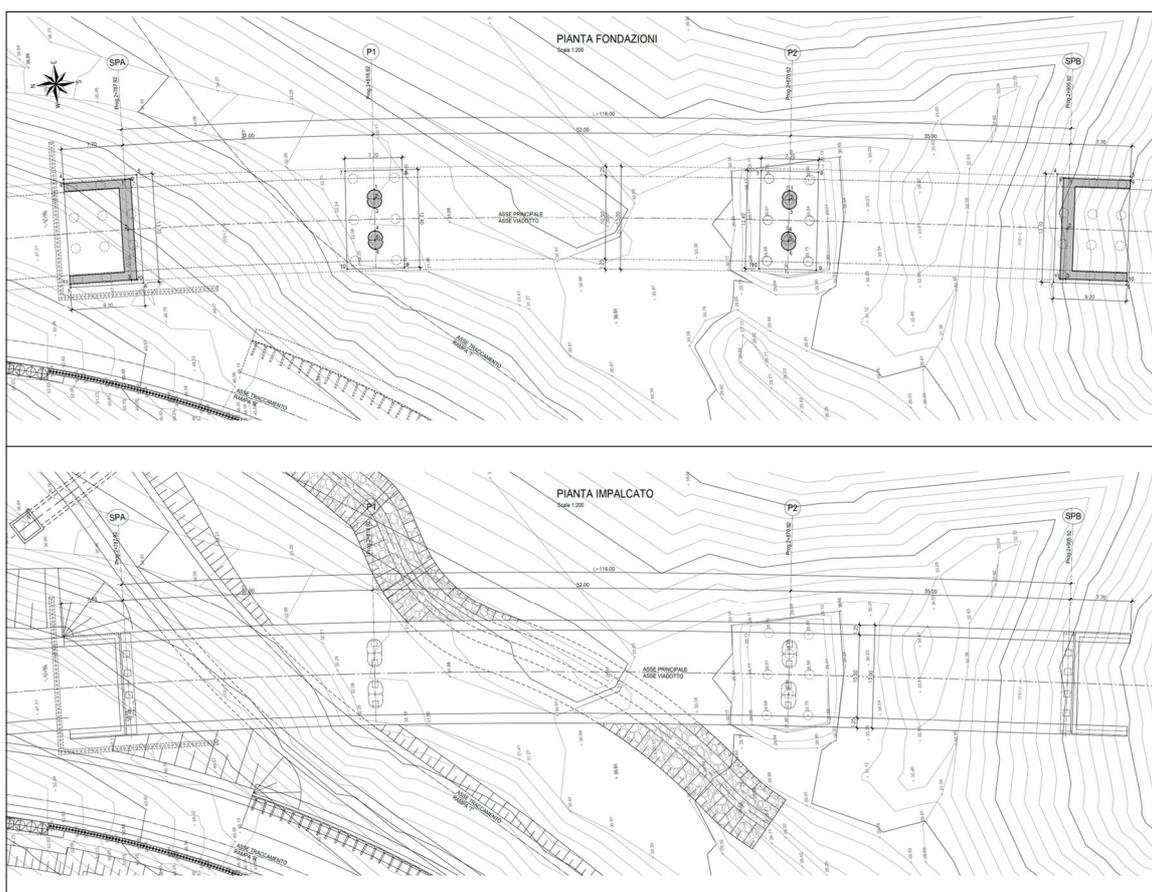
Viadotto San Venerio II – Schemi planimetrici
